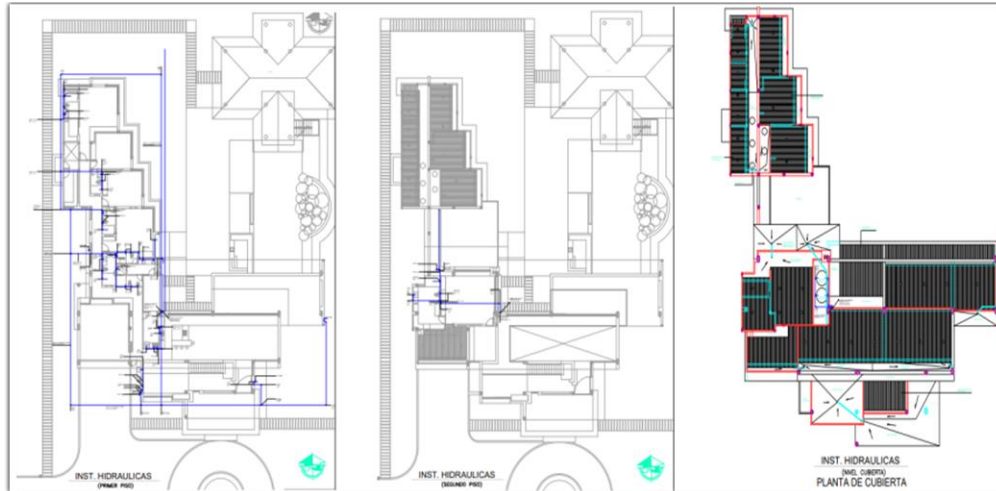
Planta de instalación hidráulica de primer, segundo piso y cubierta. Fuente: Planos AutoCAD.
